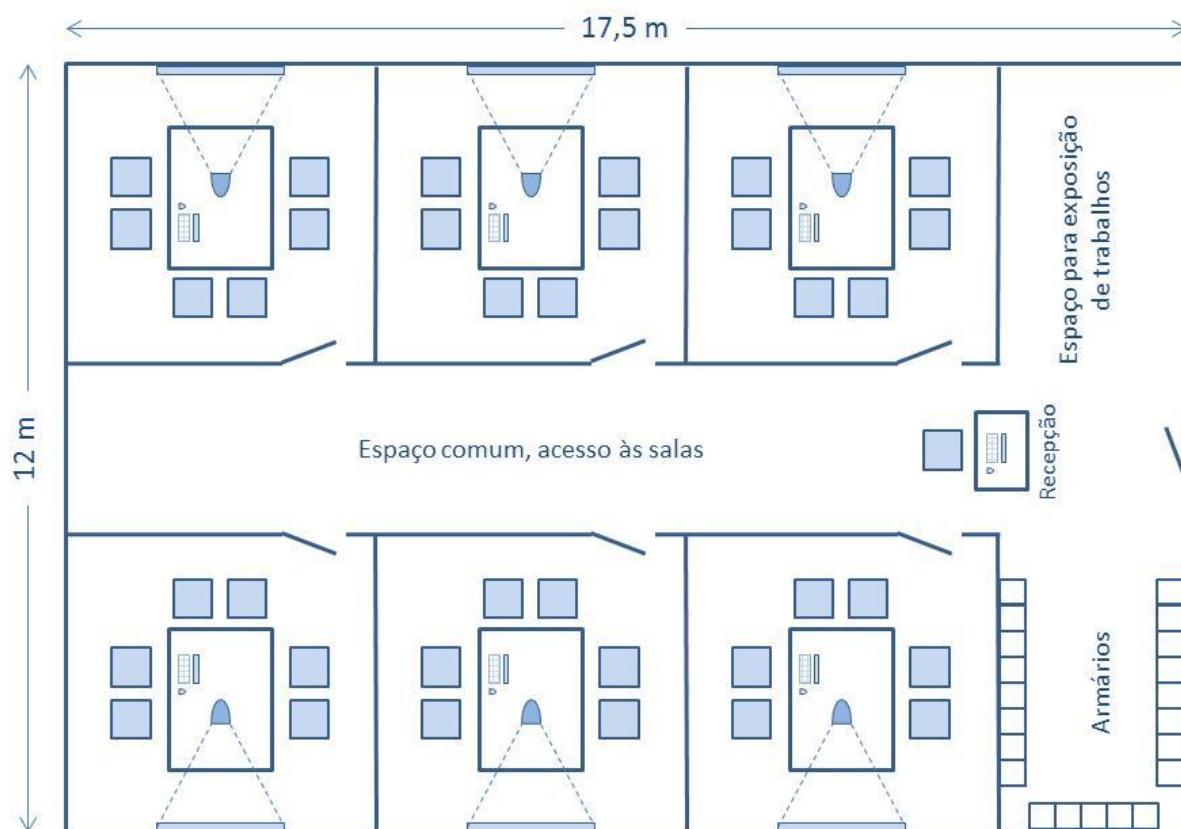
Layout proposto para as Salas de Trabalho em Equipe
